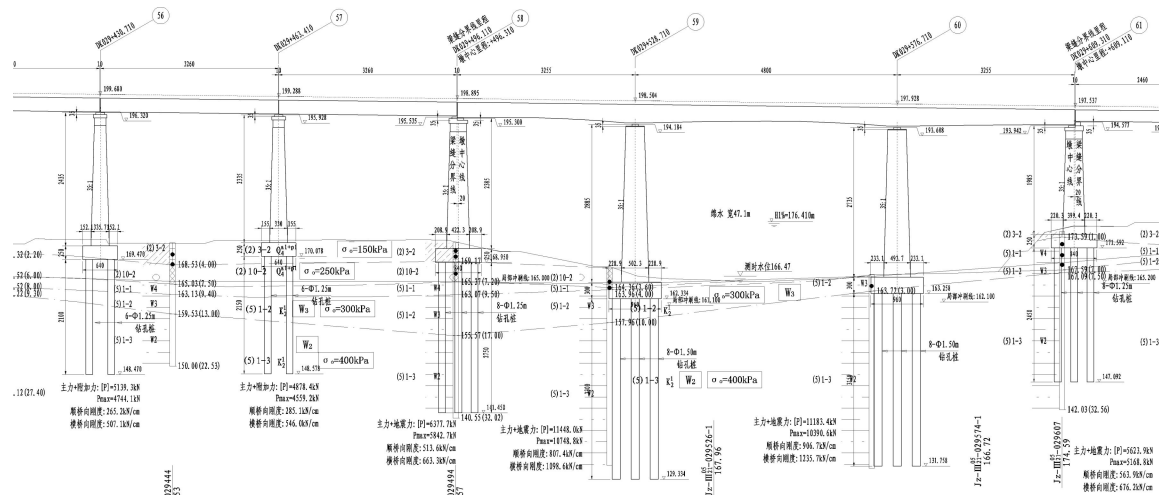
绵水特大桥主跨 48m 连续梁第一次跨越绵水立面布置图
